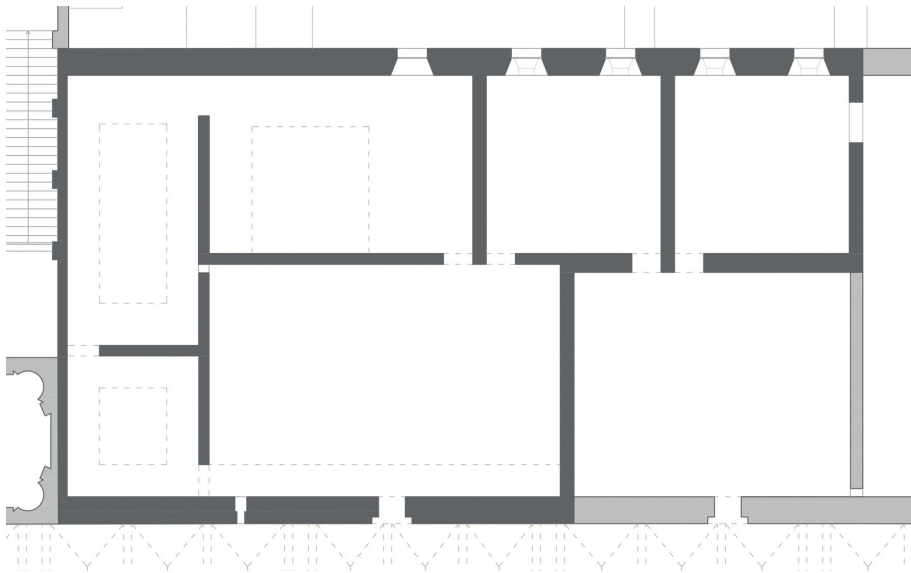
Planimetria del progetto realizzato dove si possono notare la posizione e la forma dei lucernai.
